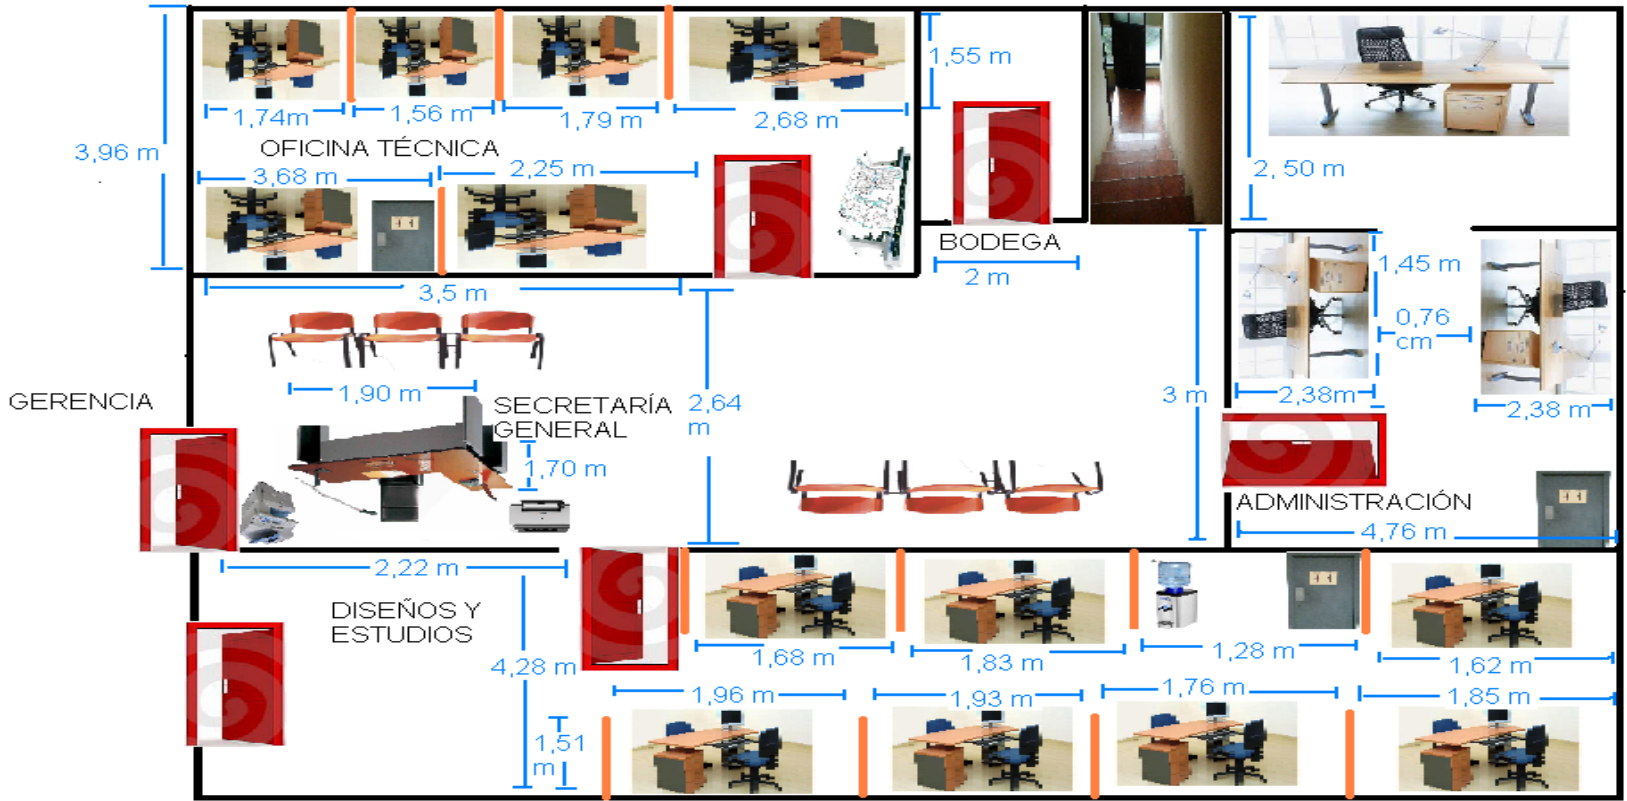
Equipamiento Y Disposición De Las Oficinas De Agua Potable Y Alcantarillado
